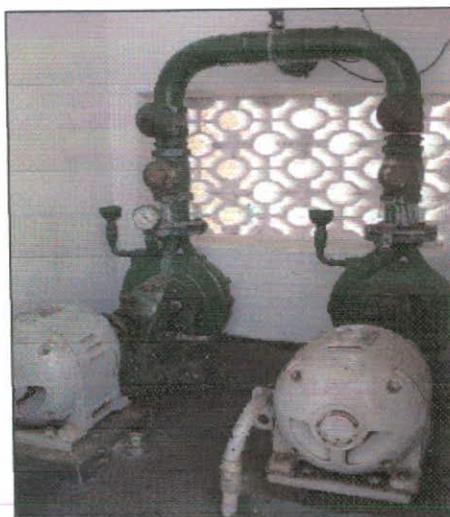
Válvulas de proteção da AAB na saída da EEB02
